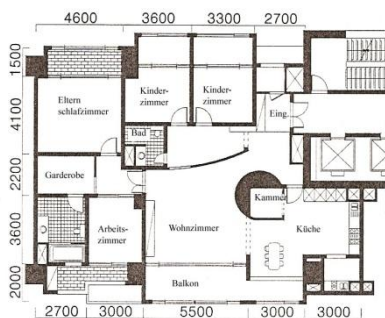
Grundriss der Bun-Dang-Wohnhochhaus-Siedlung mit einer Wohnfläche von 83m² und 154m²
